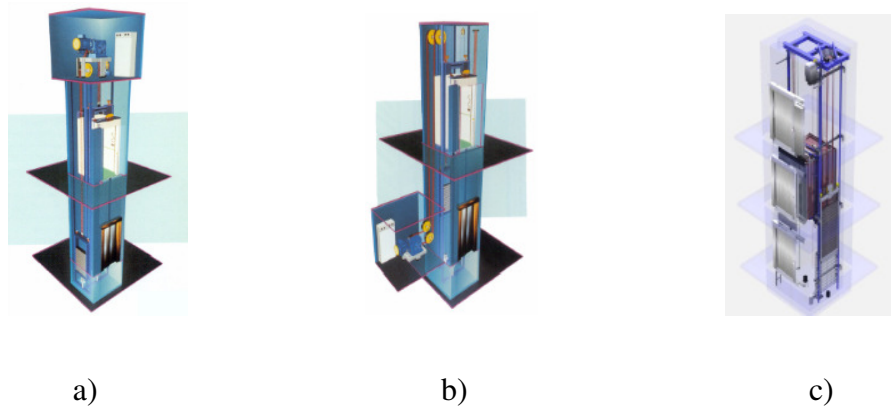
a) Elevadores com casa de máquina no topo da caixa; b) elevador com casa de máquina em baixo; c) elevador sem casa de máquina
